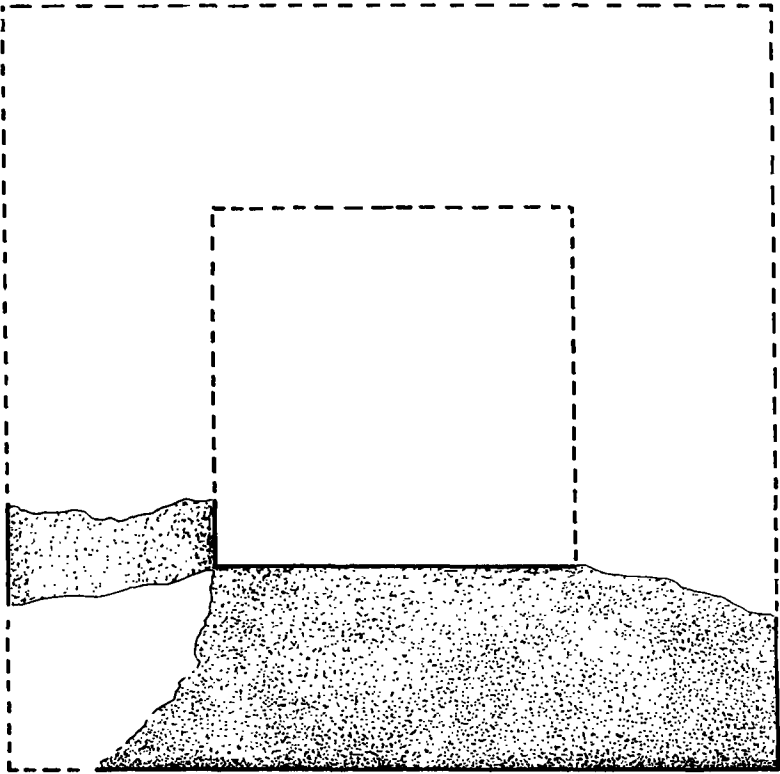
M. de Trochala. Plan et façade du mur ouest de l'église.
